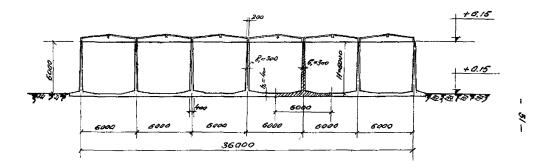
Гери зонтальный отстойных. Поперечный разрез I-I.
